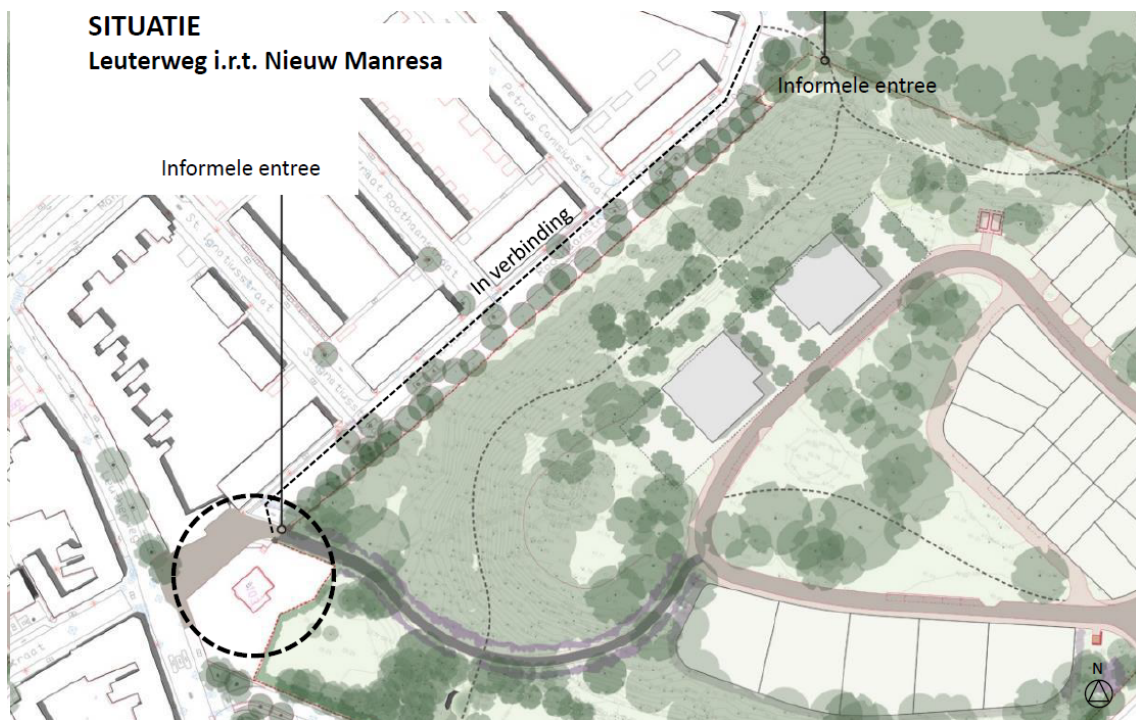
planlocatie met wegenstructuur in omgeving
